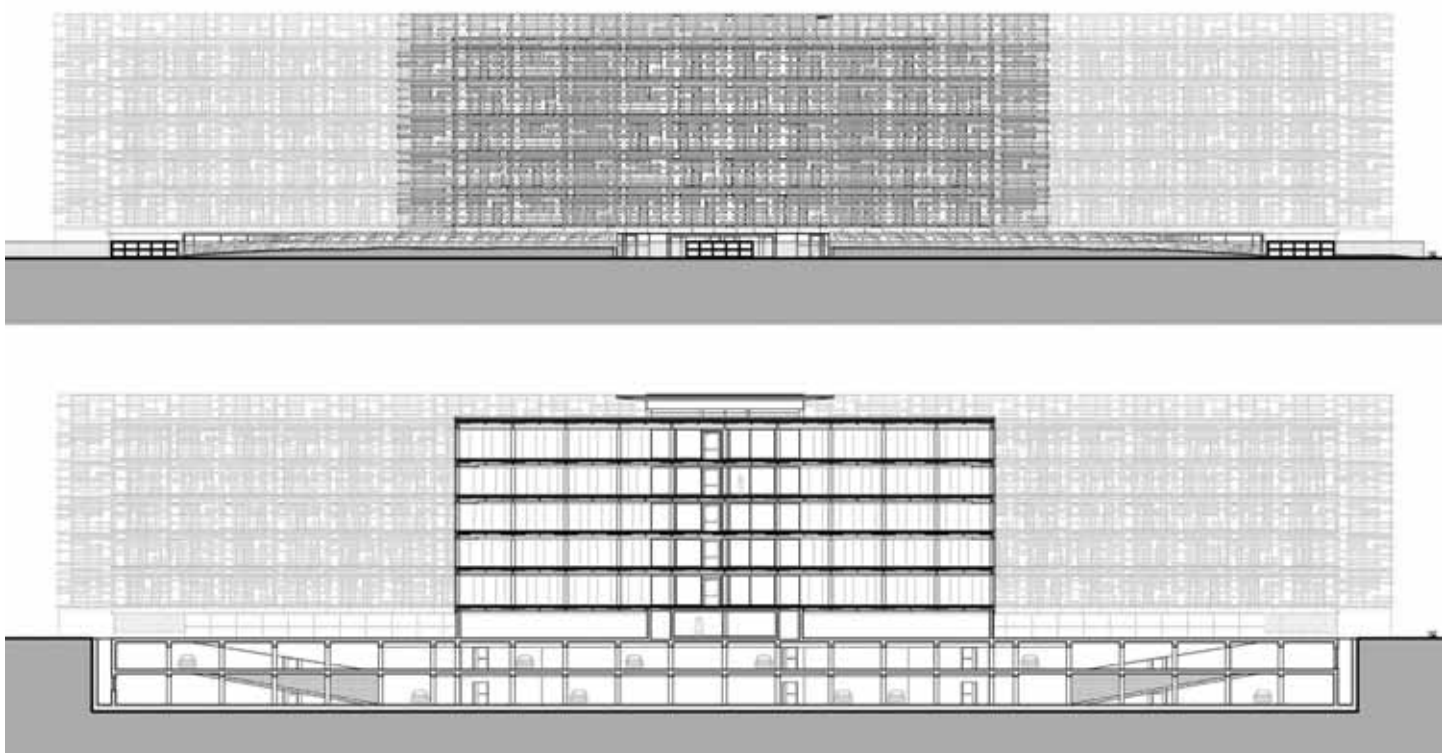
Prospetto sud-ovest (sopra) e sezione longitudinale in corrispondenza del volume sud (sotto)
